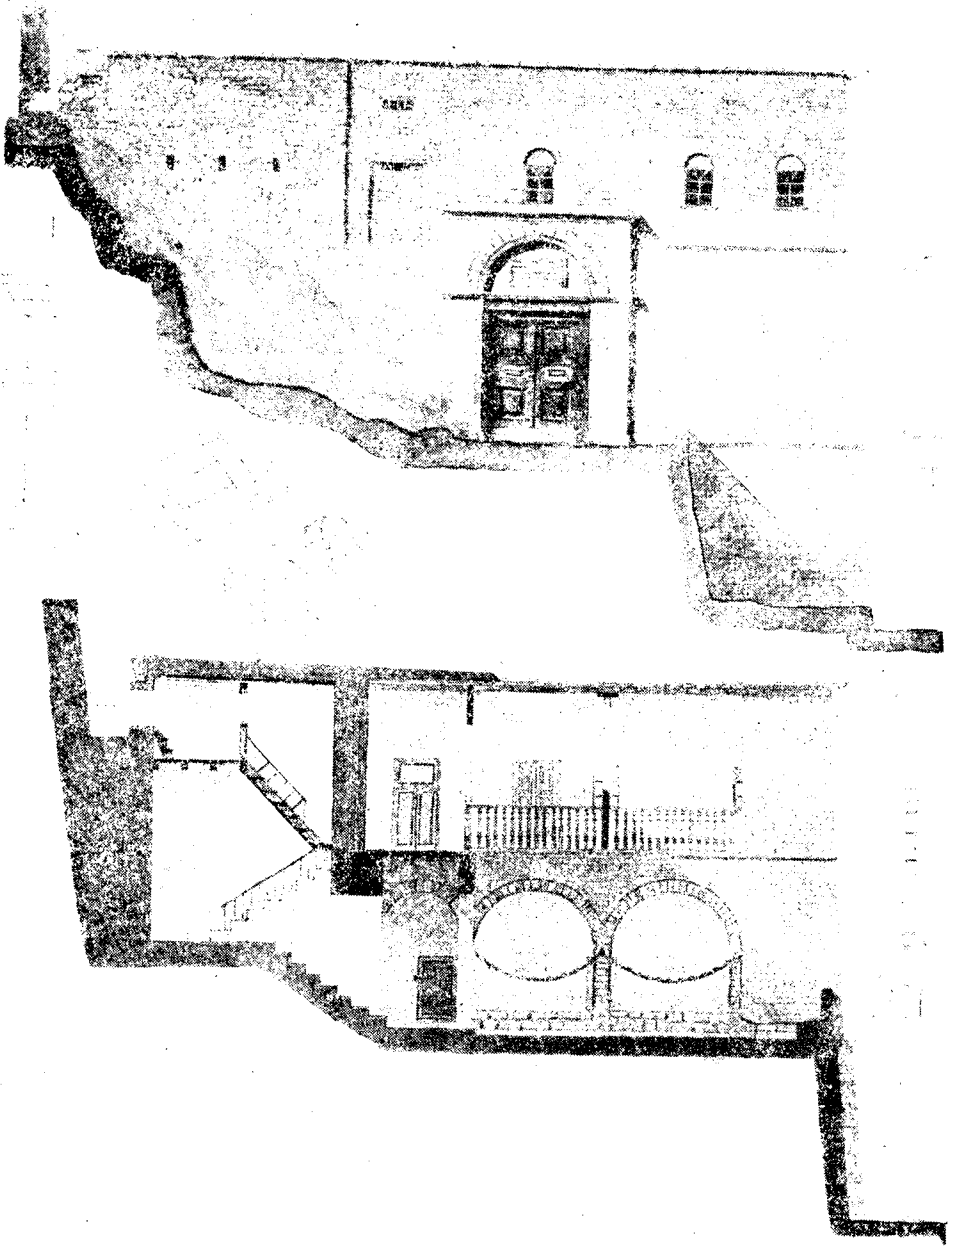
Торцовый фасад и поперечный разрез дома Нахибашева
